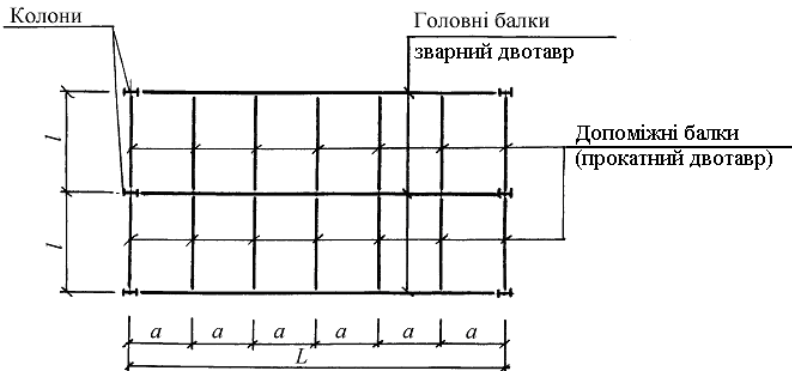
Монтажна схема балок перекриття промислового майданчика
